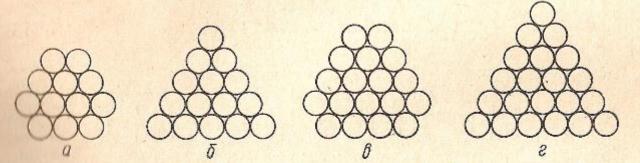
Схемы поперечных сечений трехгранных прядей, применяемых в качестве арматуры преднапряженных железобетонных конструкций:
